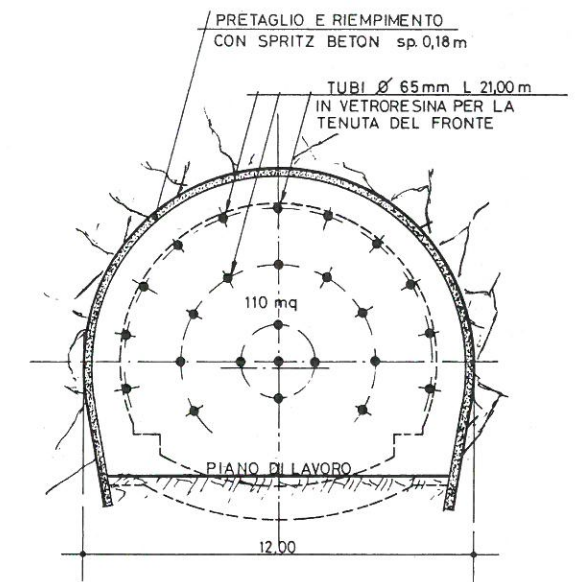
Il fronte della galleria. Si possono osservare il pretaglio a protezione dello scavo ed i tubi in vetroresina.
